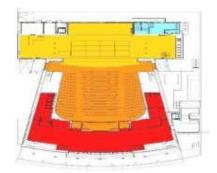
Plantas do segundo.piso Fonte: Calor, 2004
